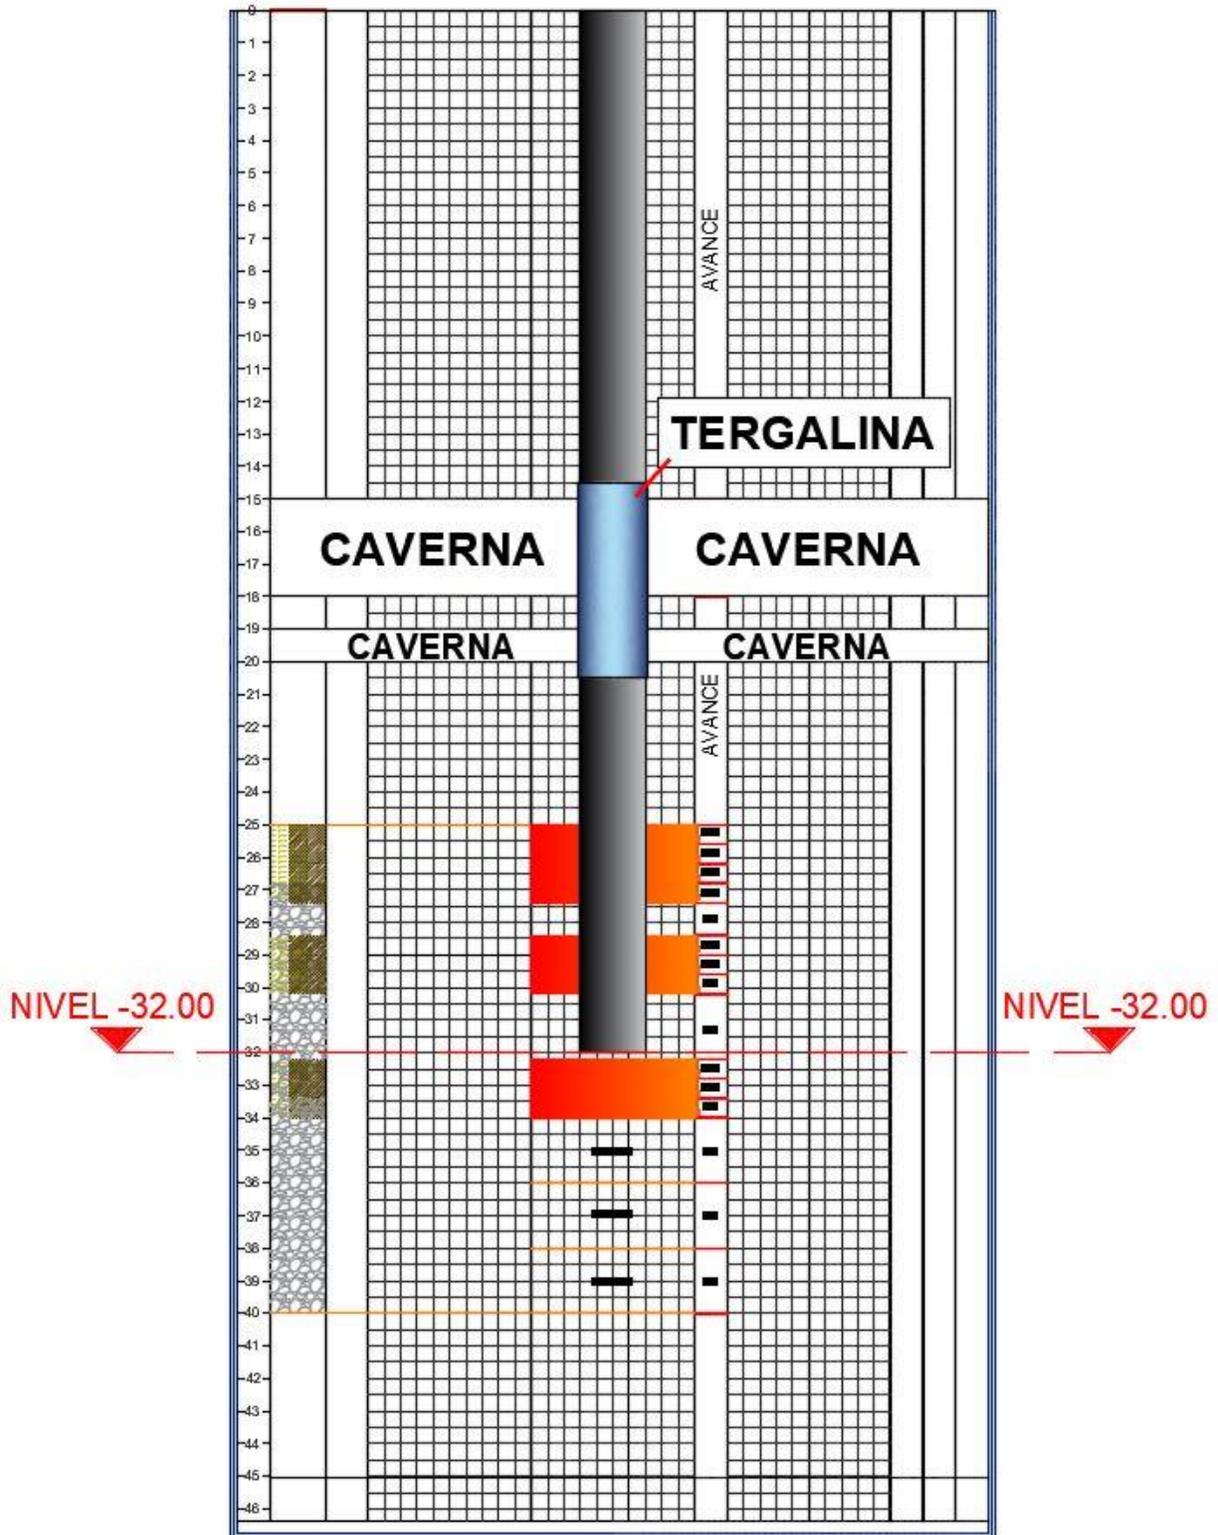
PILA 18 (SM-18 EJE F6).
